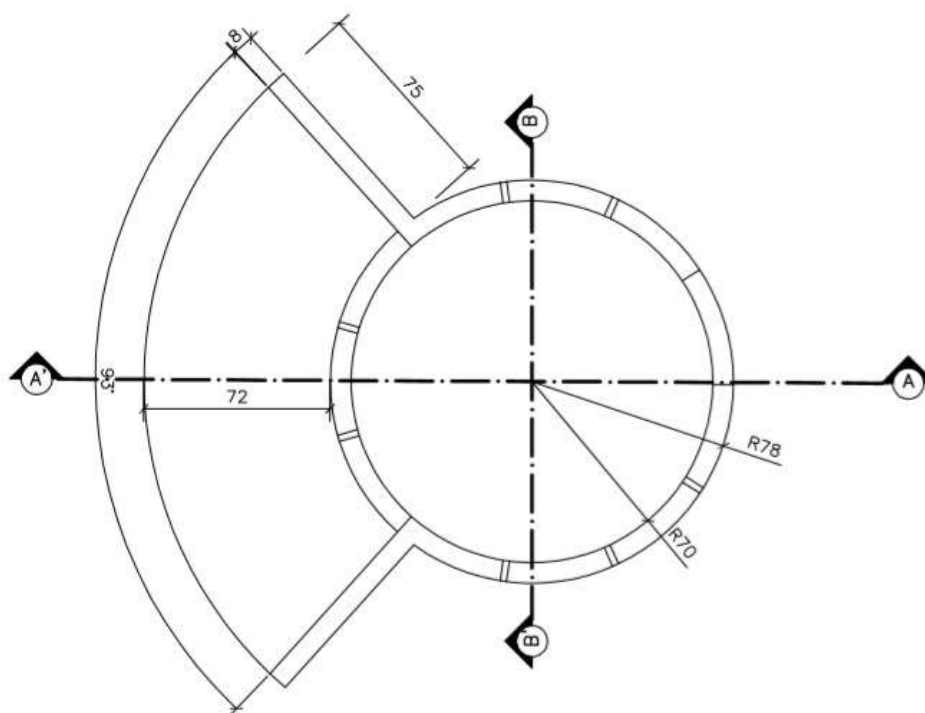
Caixa de Sedimentação com entrada canaleta - Planta
